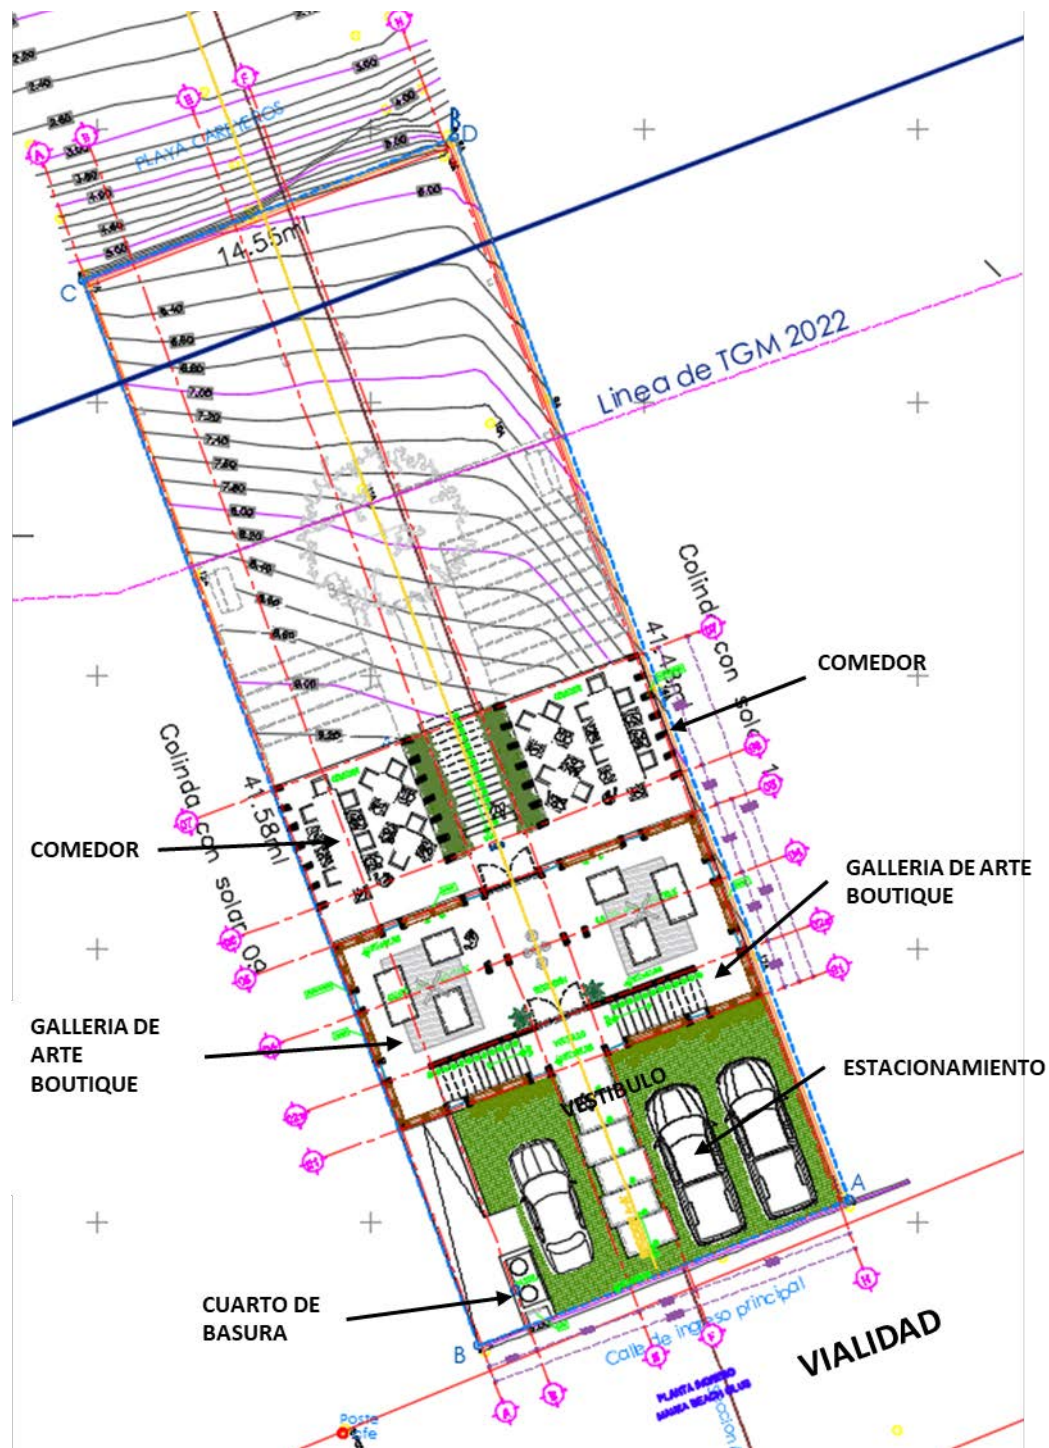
PLANTA NIVEL +3.22 ALTA
